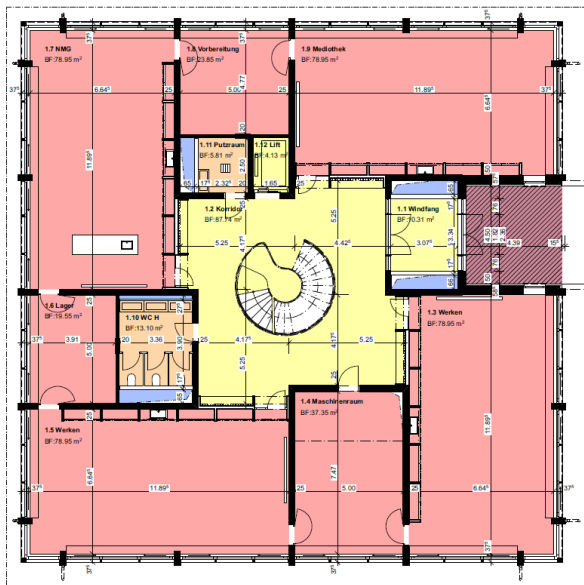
Neubau H4 – Grundriss EG &amp; OG
